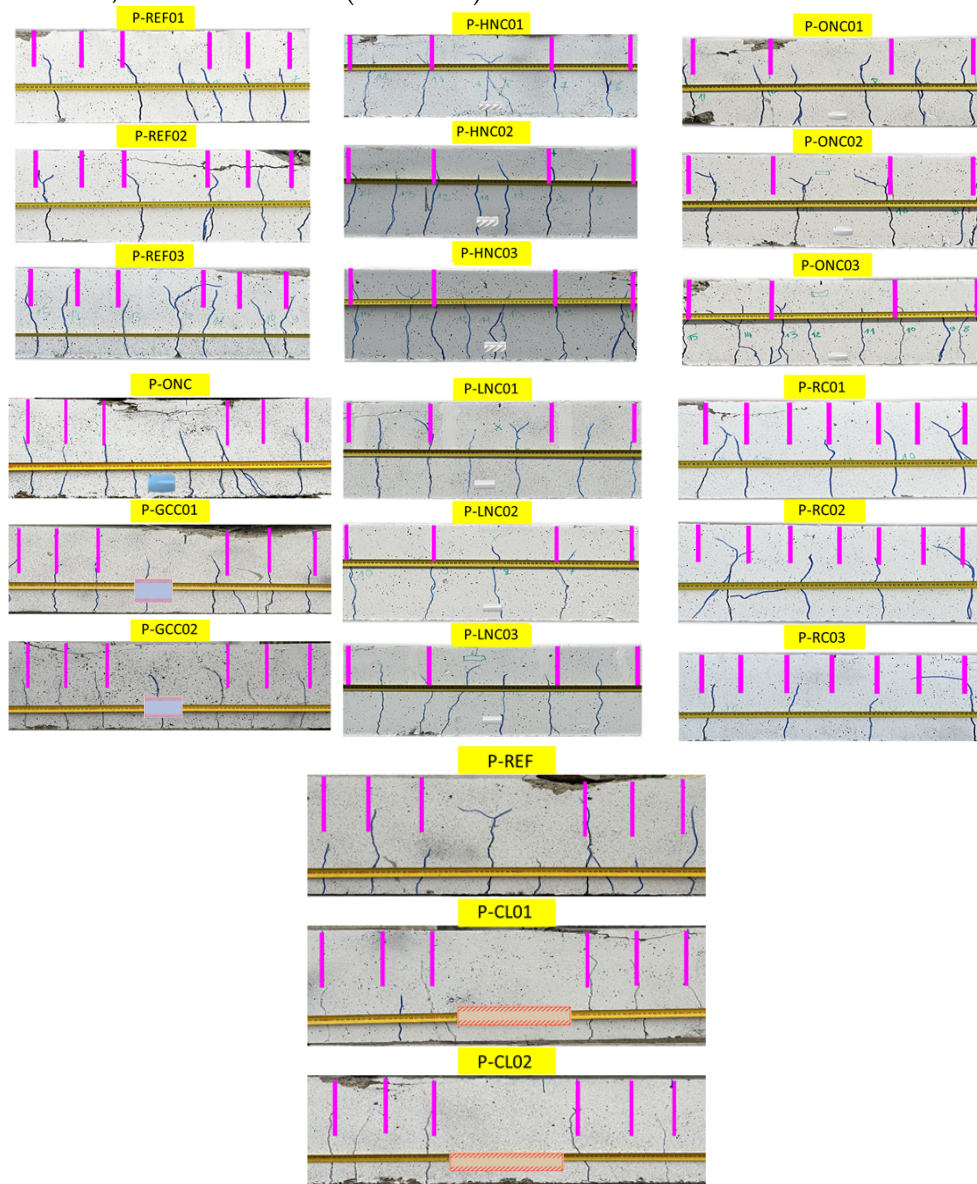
Etat de fissuration des poutres avec différentes configurations de liaisonnement après la rupture
